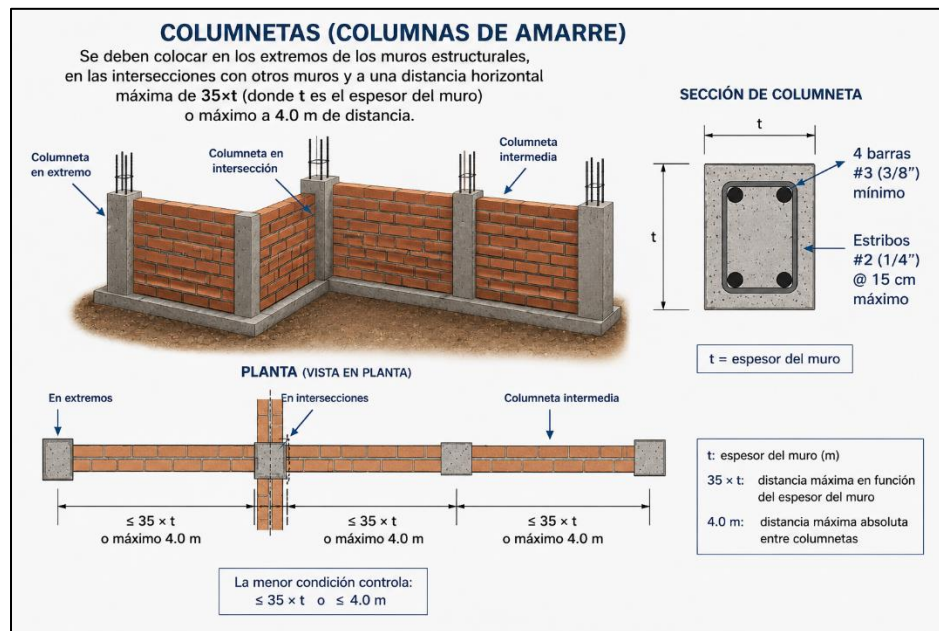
Ubicación y disposición de las columnetas (columnas de amarre) en muros de mampostería confinada según la NSR-10. Fuente: Elaboración Propia.
